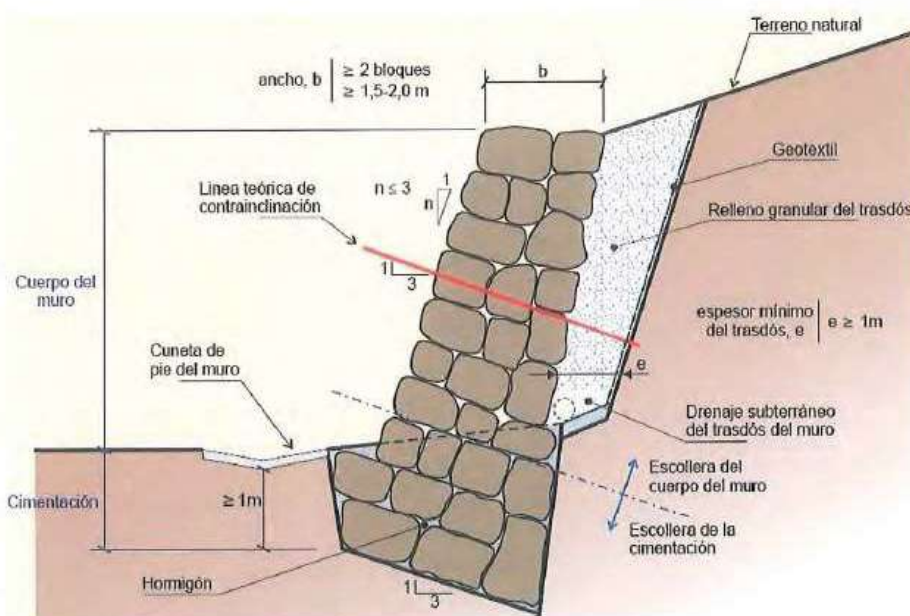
Sección talud. Fuente: Guía para proyecto ejecución muros escollera...[Consulta: Oct-2022]
